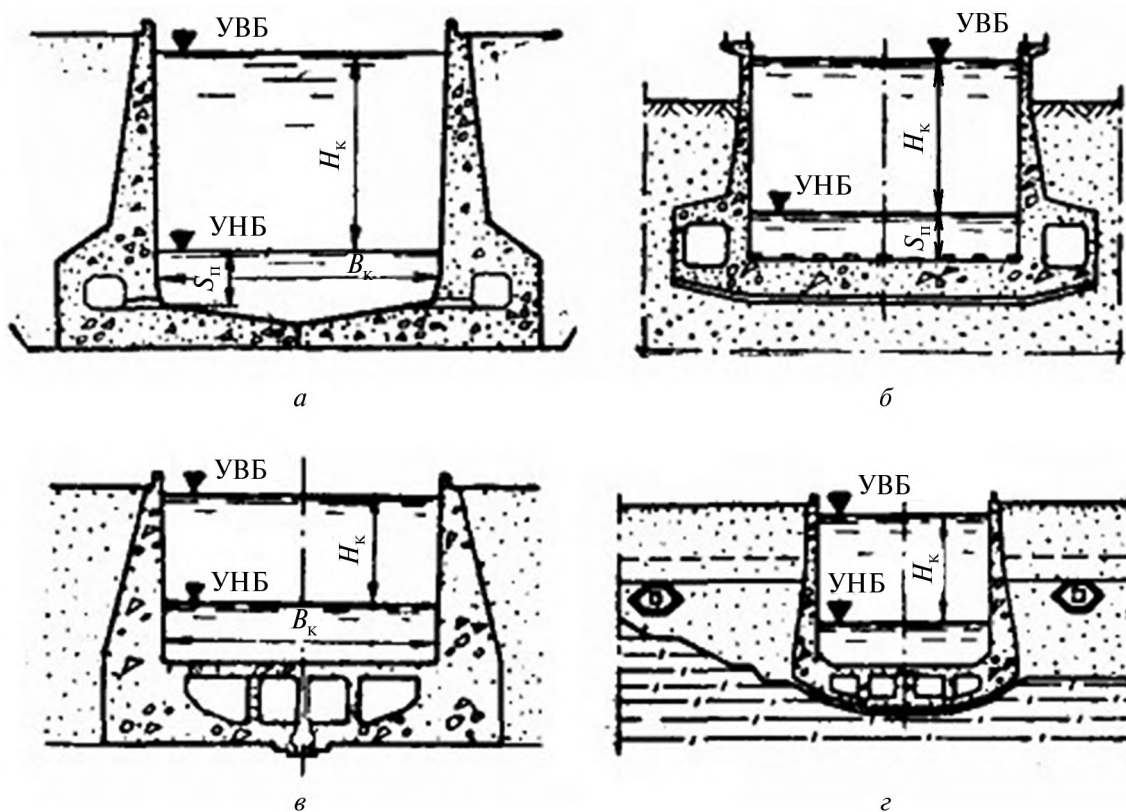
Железобетонные камеры шлюзов с продольными водопроводными галереями: а — с рамными стенами и разрезным днищем; б — то же с неразрезным днищем; в — со стенами прямоугольного сечения и временно-разрезным днищем; г — то же с неразрезным рамным днищем
